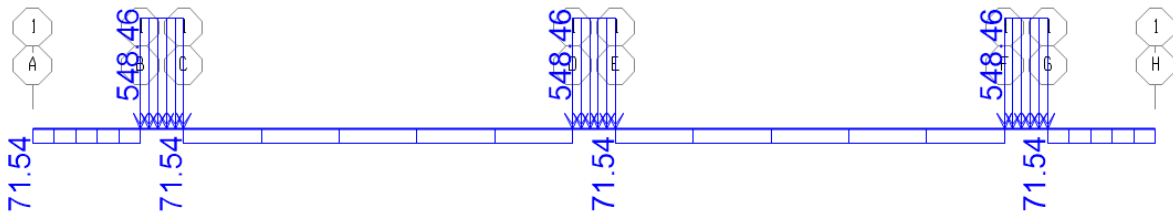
Cargas aplicadas sobre el modelo de viga generado en SAP2000.v20.
